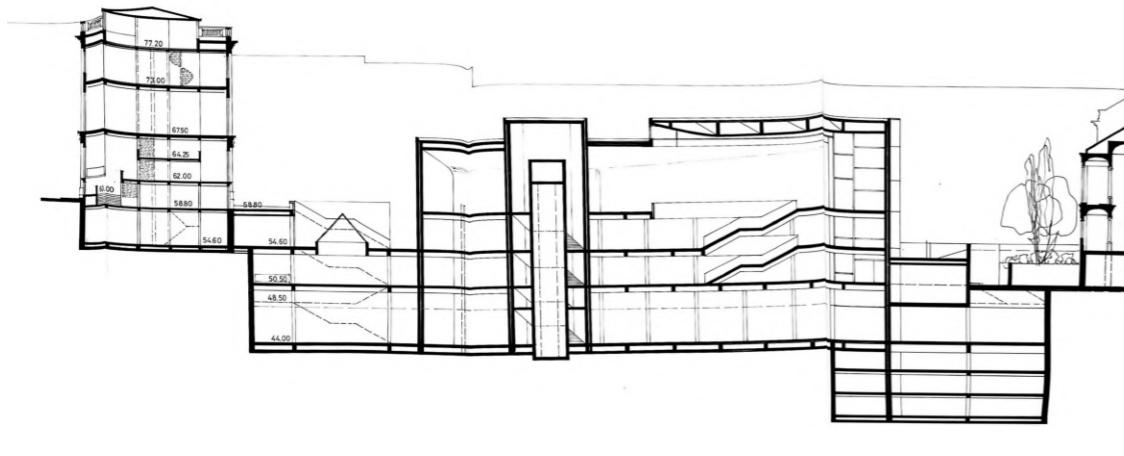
Coupe longitudinale, 6^{ème} esquisse v3.
